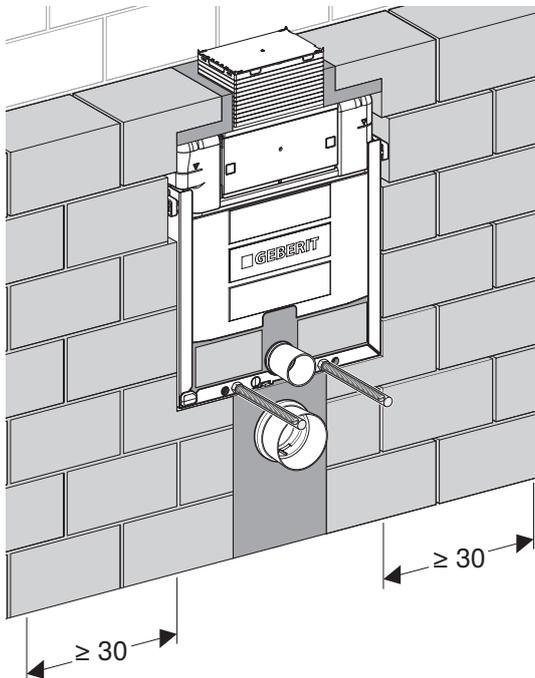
Geberit Kombifix Element für Wand-WC eingemauert in einer Nassbau-Vorwand
